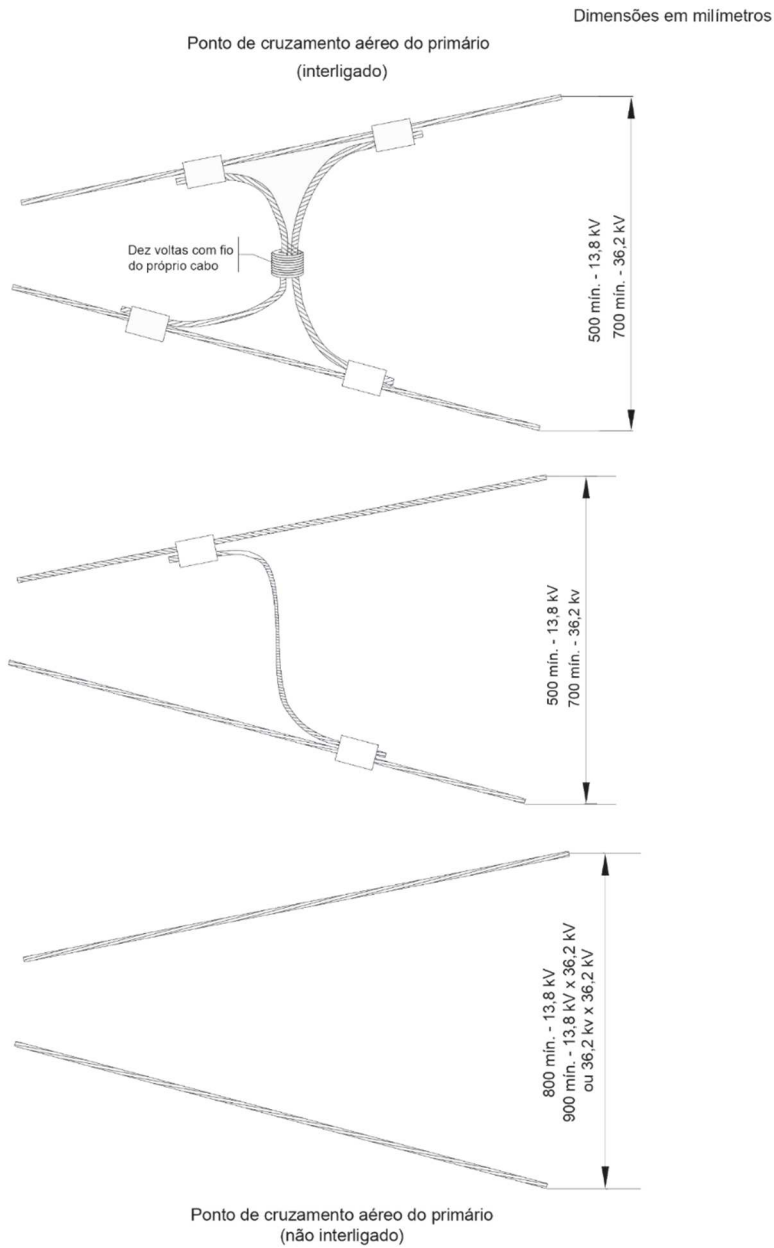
Amarrações e ligações – Primário - Detalhe do cruzamento aéreo
